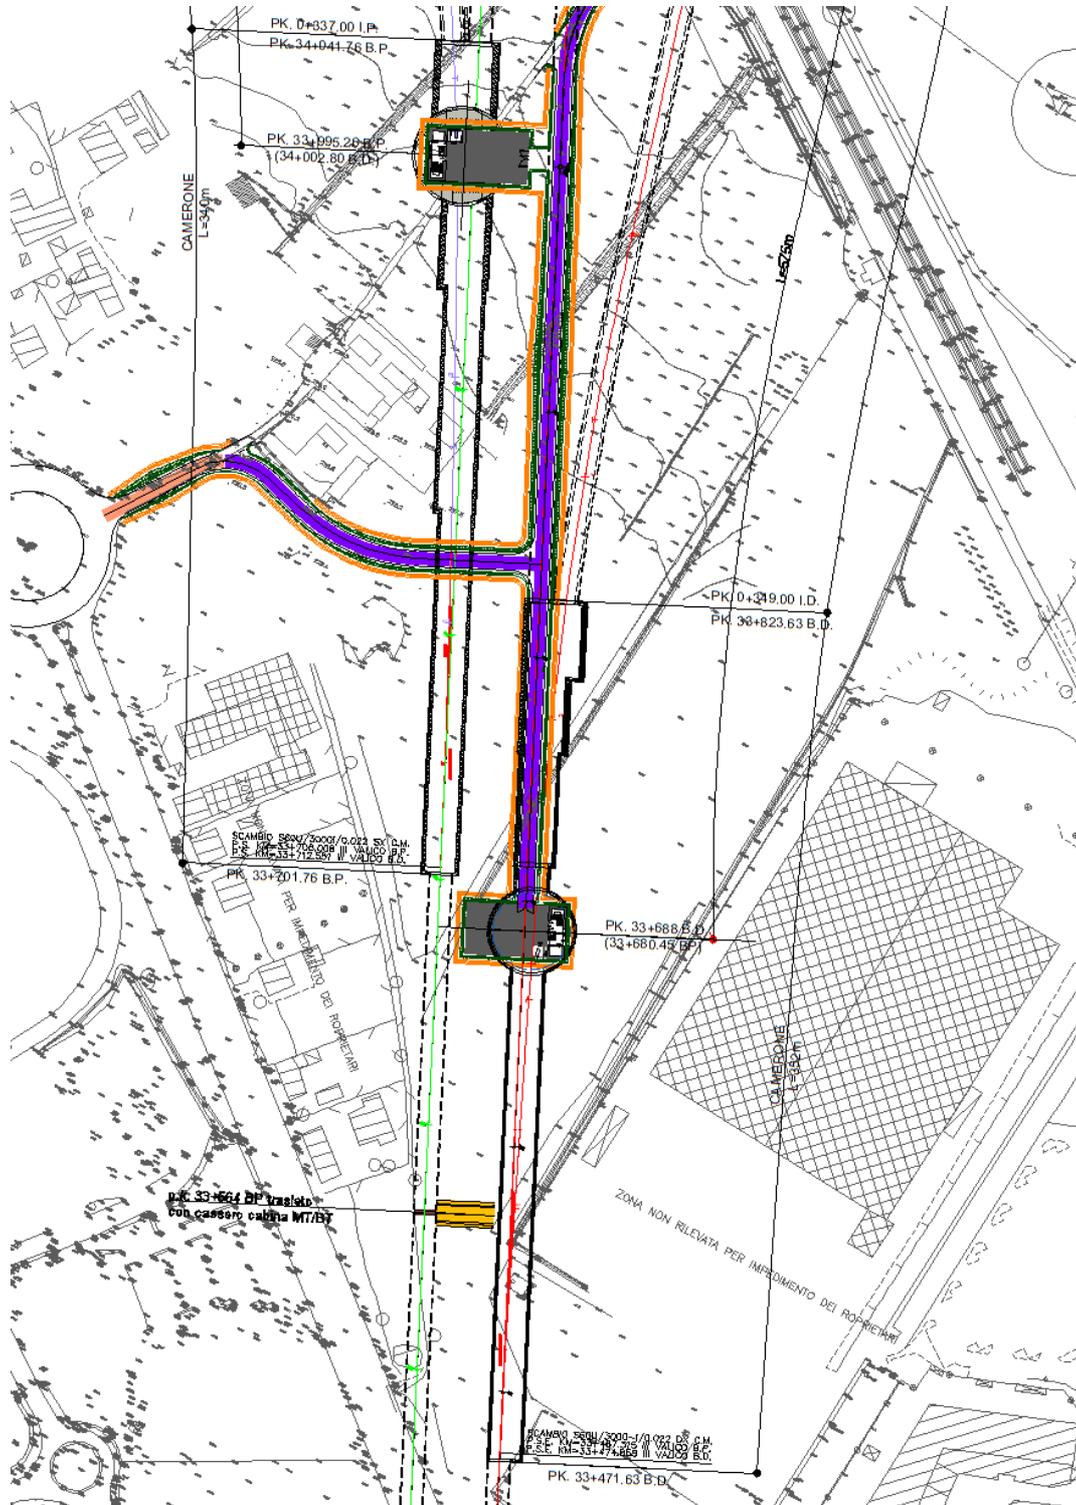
Schema planimetrico dell'ubicazione delle opere dei camerone riferite ai binari
